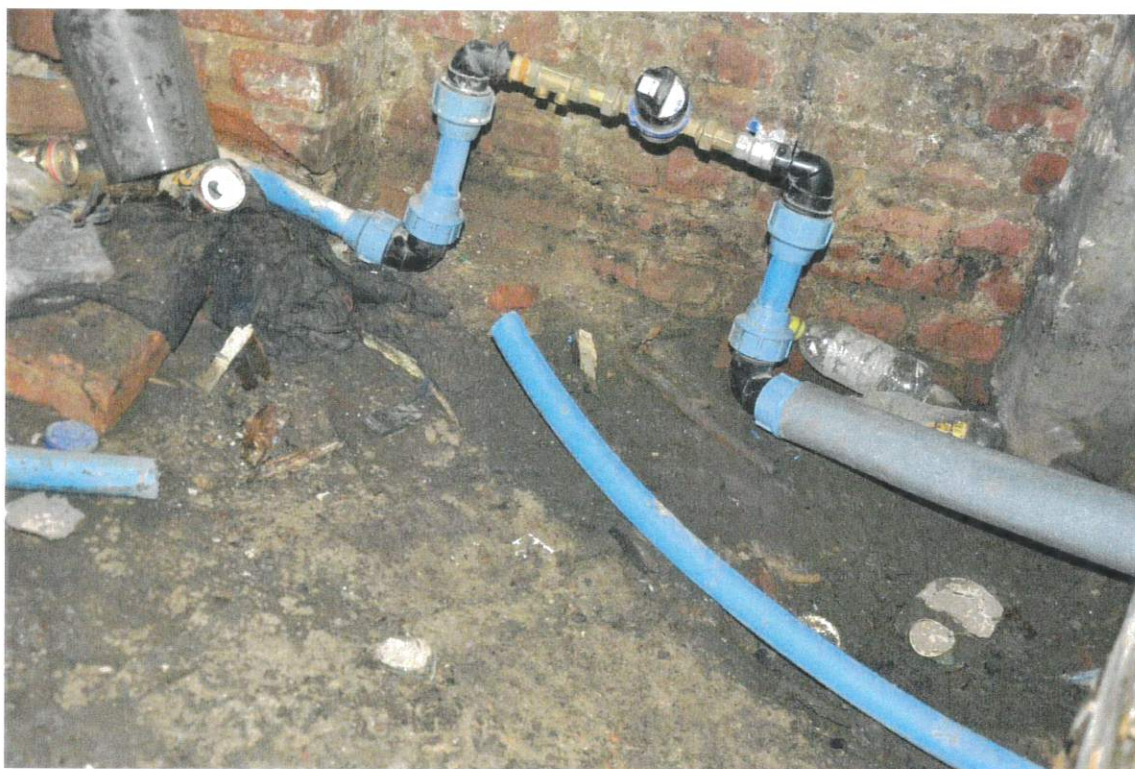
Piwnica – silne zawilgocenie ścian, zagrybienie elementów drewnianych i muru
